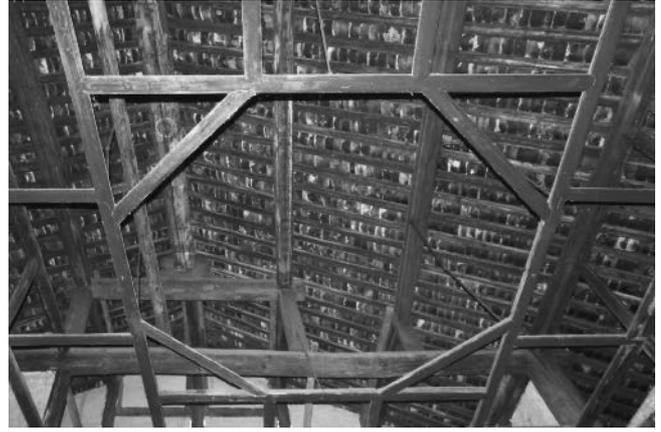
Dachtragwerk im Schulhaus (Raum 010)
